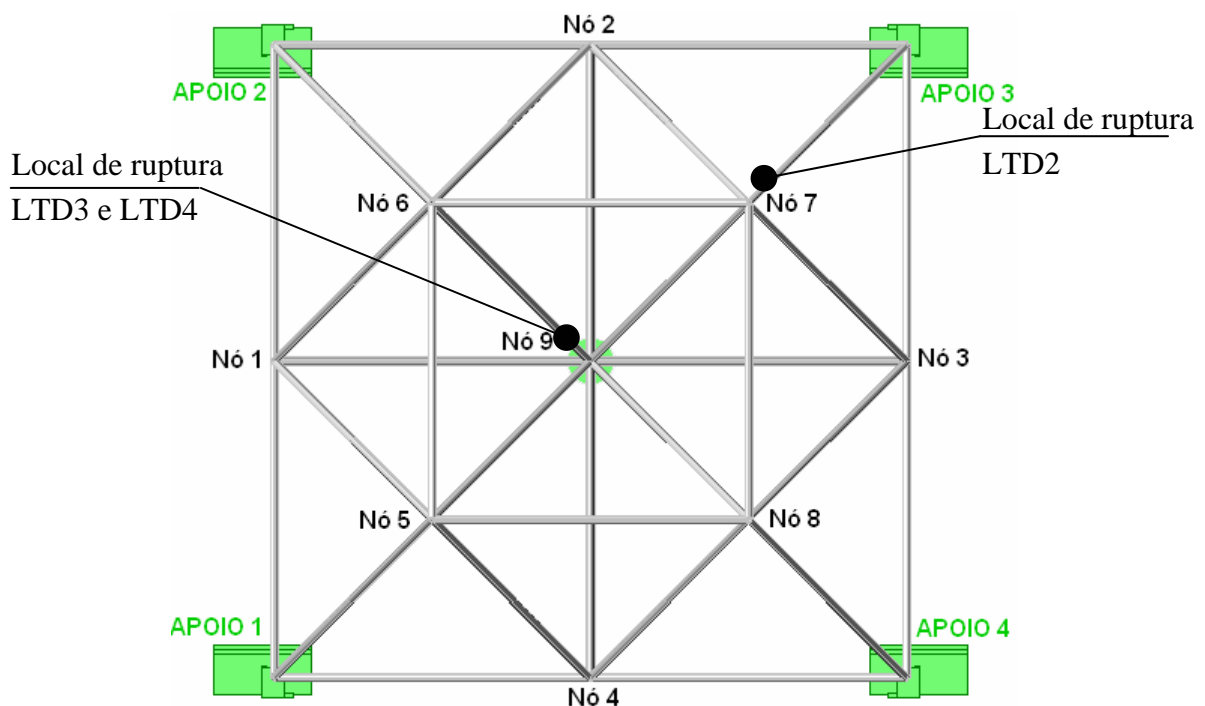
Planta de localização das barras rompidas durante ensaio dinâmico - LTD
